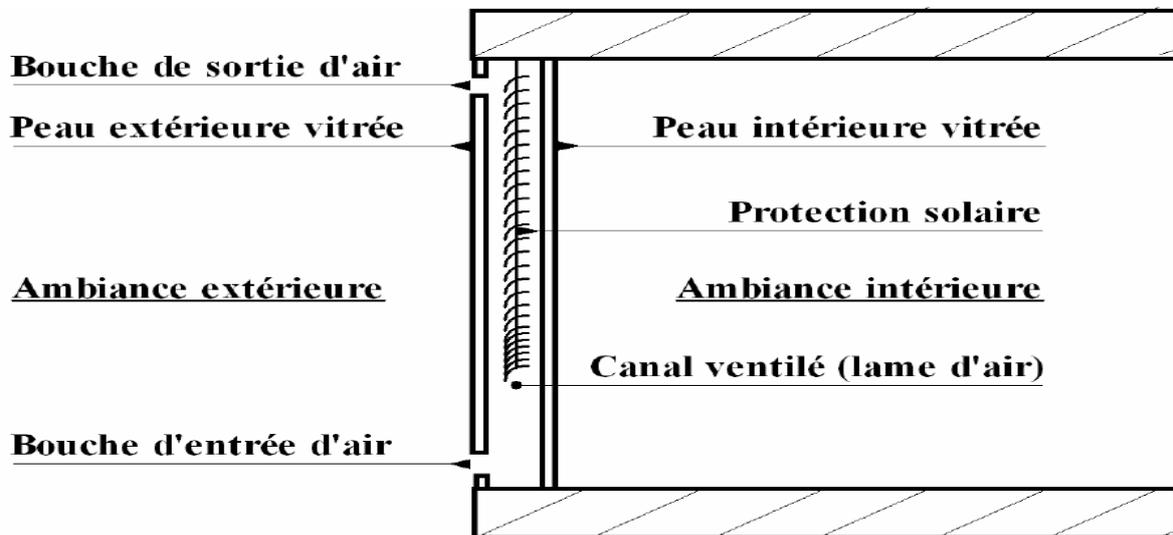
Les composants d'une façade double peau .(Source : khadraoui.2019)
